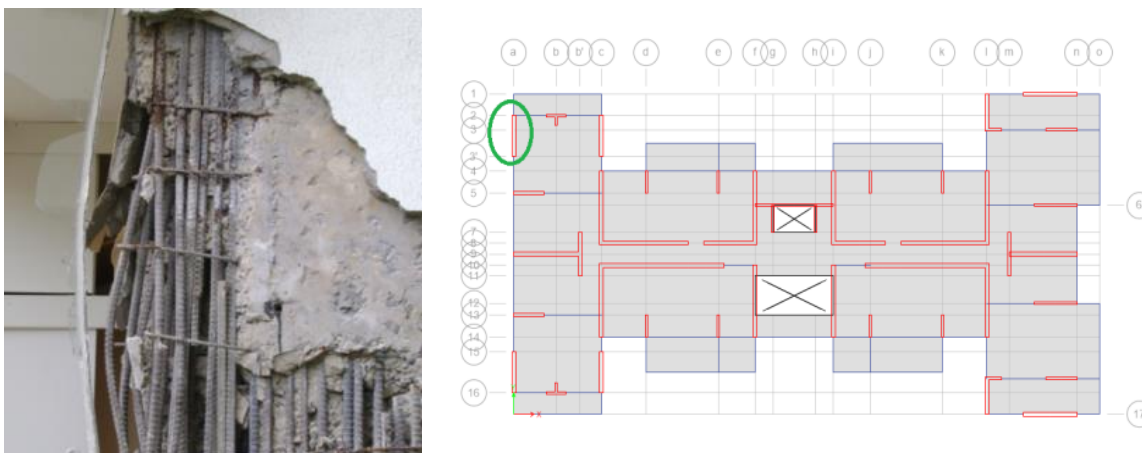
Imagen del daño y ubicación en planta del elemento F5-1
